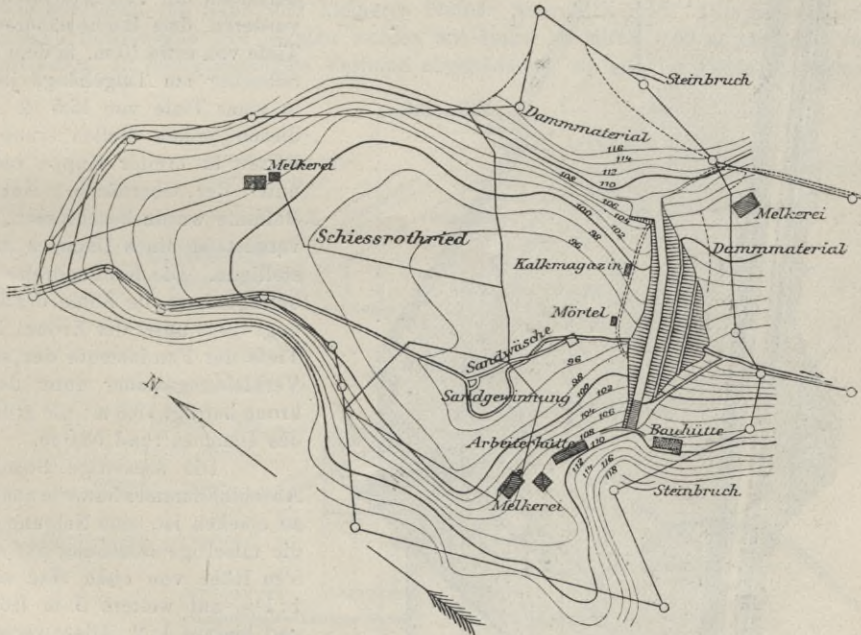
Lageplan des Schießrothried-Dammes. 1:5000.
